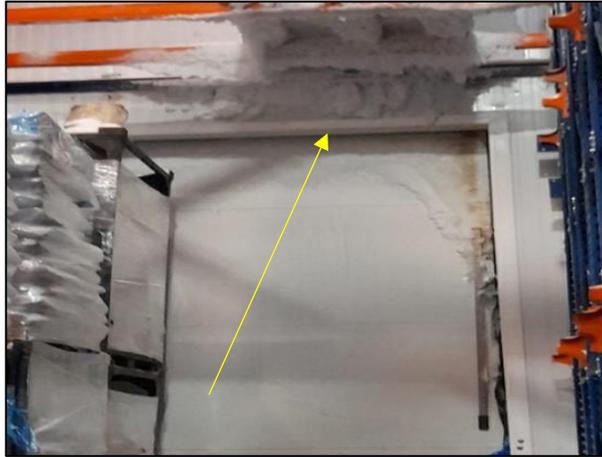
Escarchado en la puerta interna de la cámara por jebe roto
